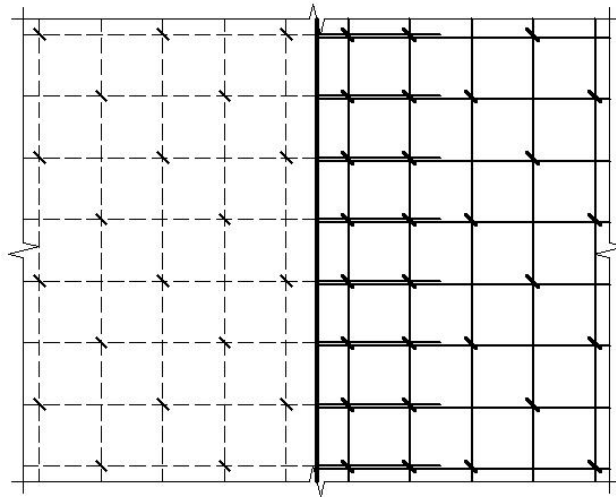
Схеми з'єднання арматурних сіток
